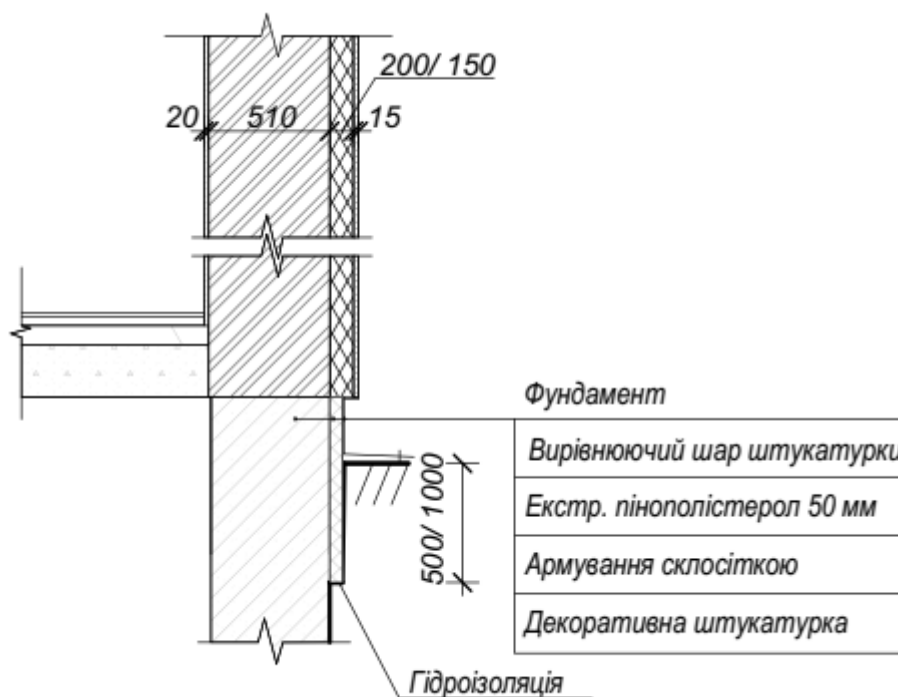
Фрагмент утеплення та гідроізоляції фундаменту.
